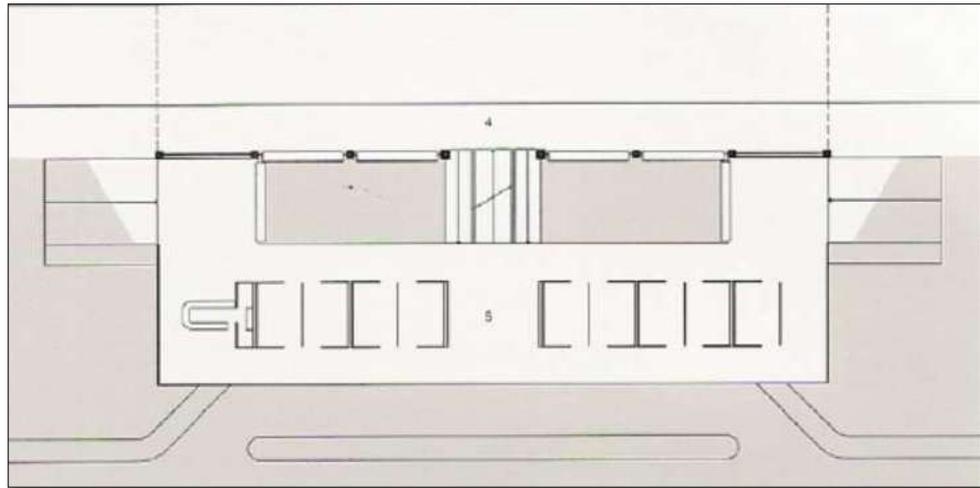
Planta do pavimento intermediário – banheiros e comércios
